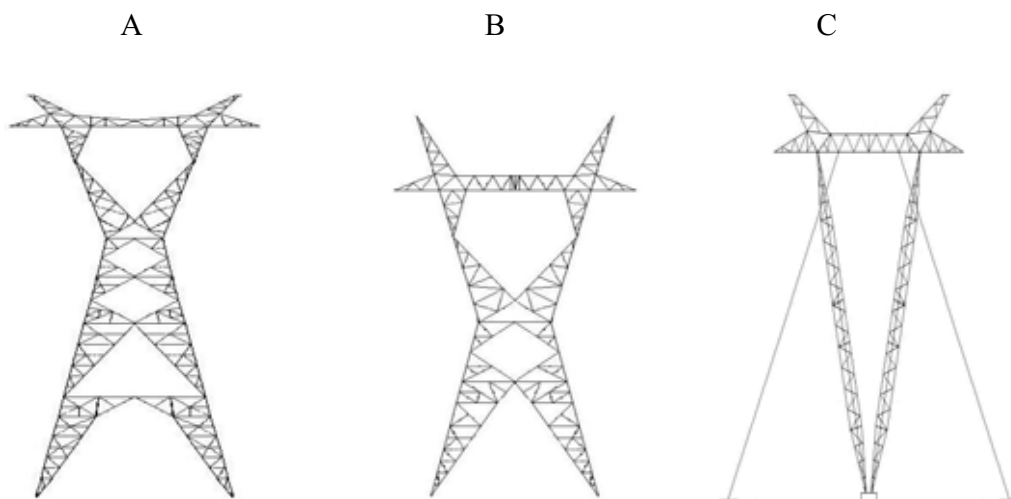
Tipos (*design*) de torres encontradas na área de estudo. A: (SP) autoportante; B: (RB30) ancoragem; e C: (SB) estaiada.
